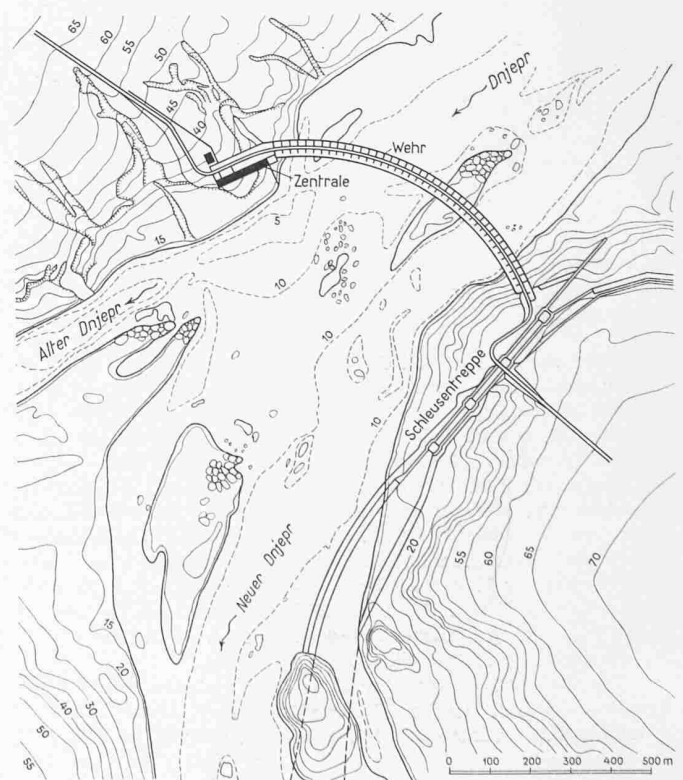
Kraftwerk Dnjeproströj, Lageplan 1 : 18 000
